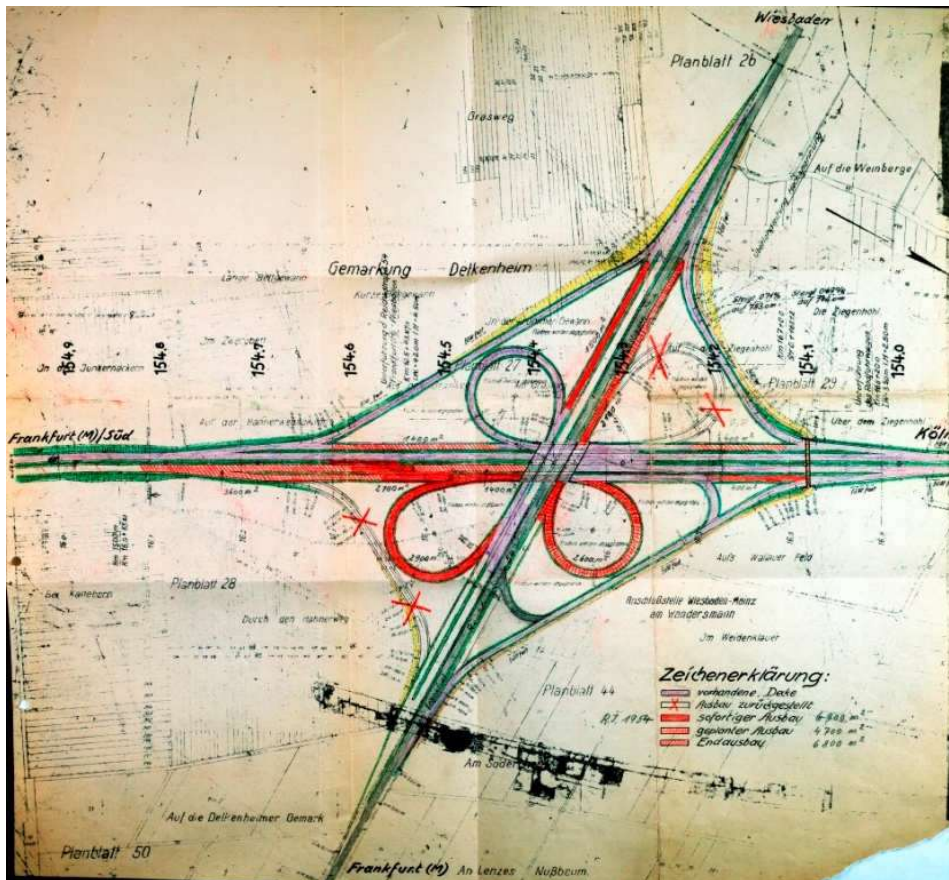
Planung der Autobahnkreuzung bei Wiesbaden (Planausrichtung nach Westen)
